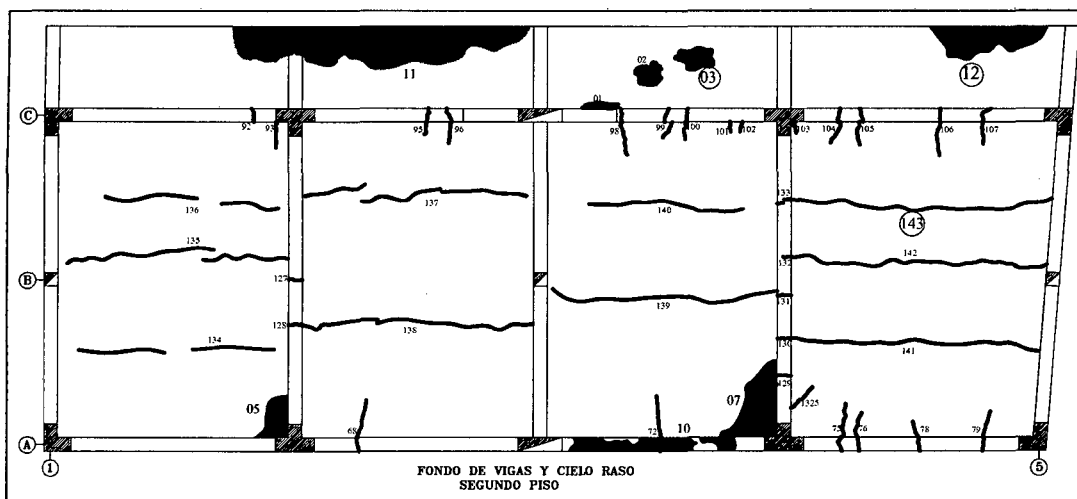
Lesiones existentes en losa (cielo raso y fondo de vigas segundo piso)
